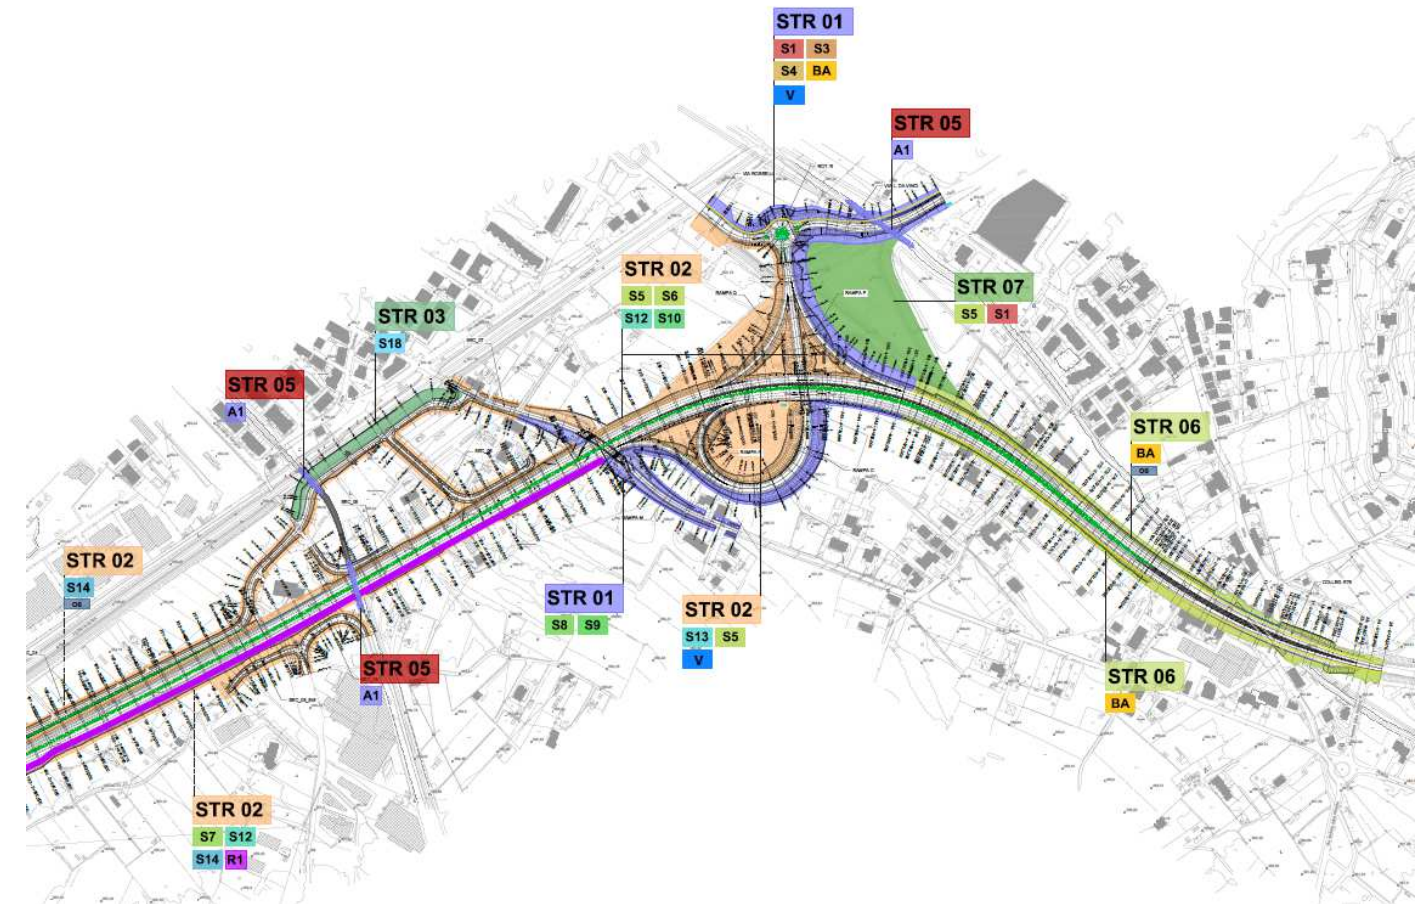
Estratti delle planimetrie di mitigazione T00AM04AMBPL01/02/03
